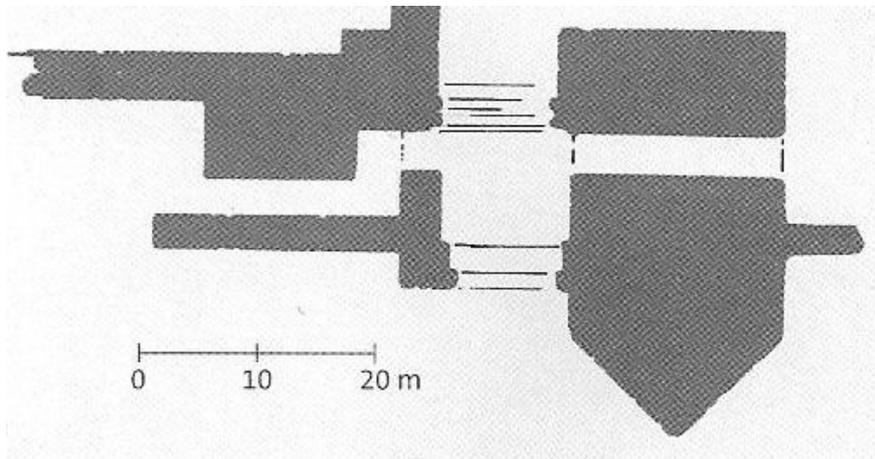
Stadtter Puerta de Cantalapedra, Madrigal de las Altas Torres, Grundriss
